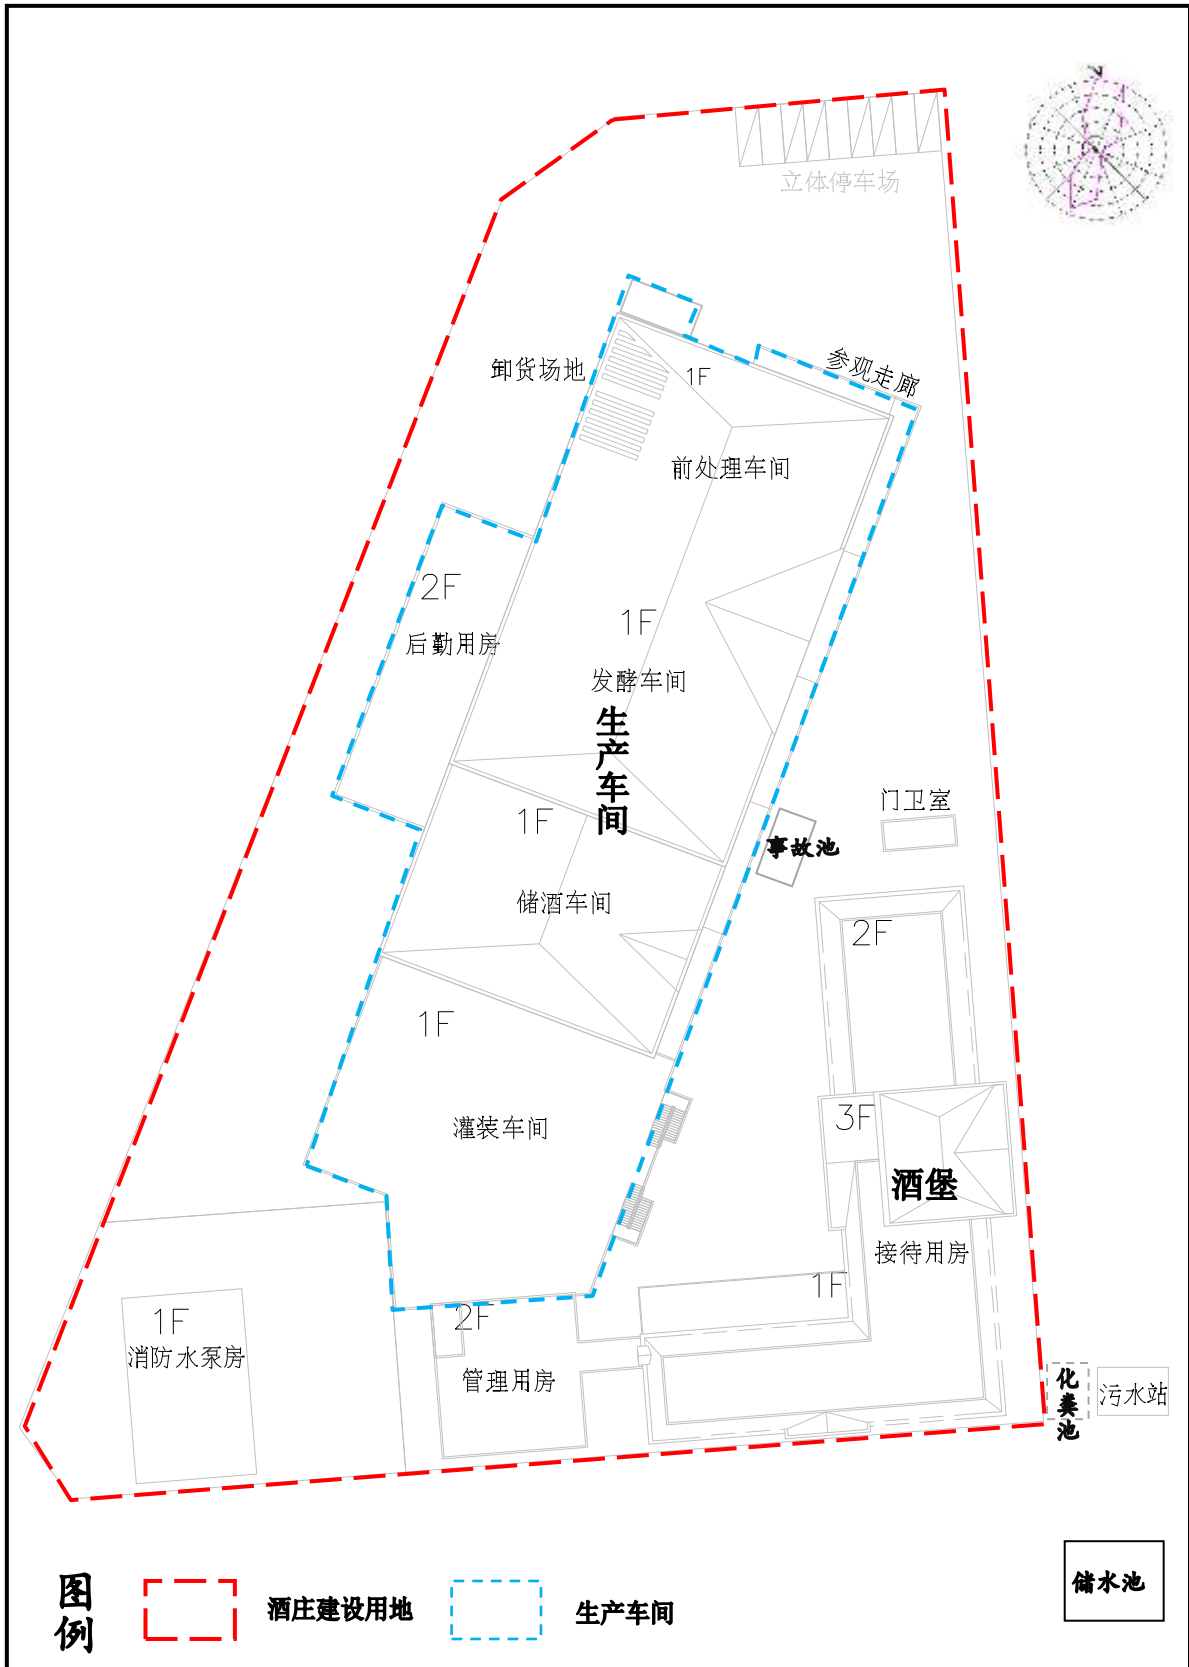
环评阶段酒庄建筑及项目车间平面布置图
